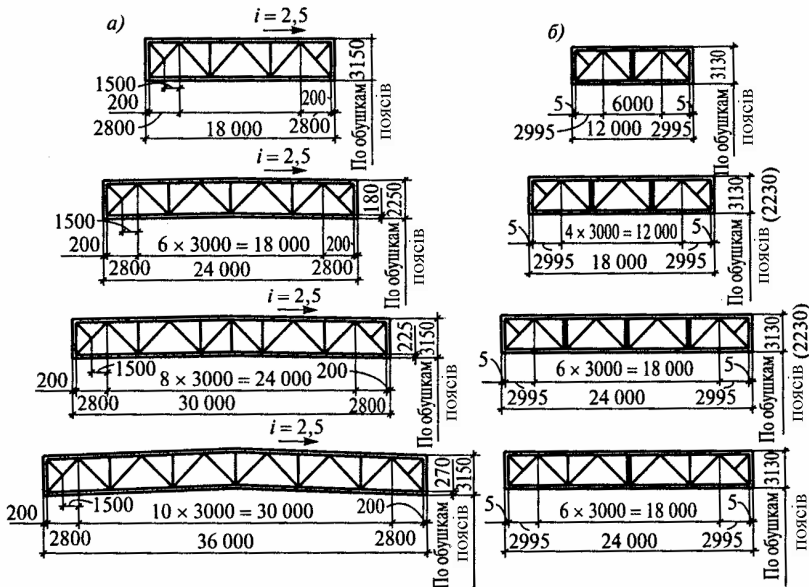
Типові схеми кроквяних (а) і підкроквяних (б) ферм для покриттів з ухилом покрівлі 2,5%
